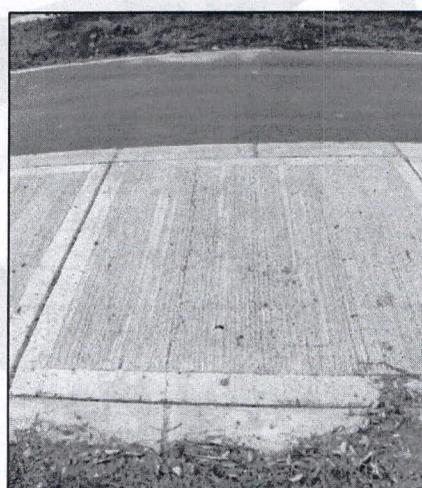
Fisura anden perimetral entre lagc
